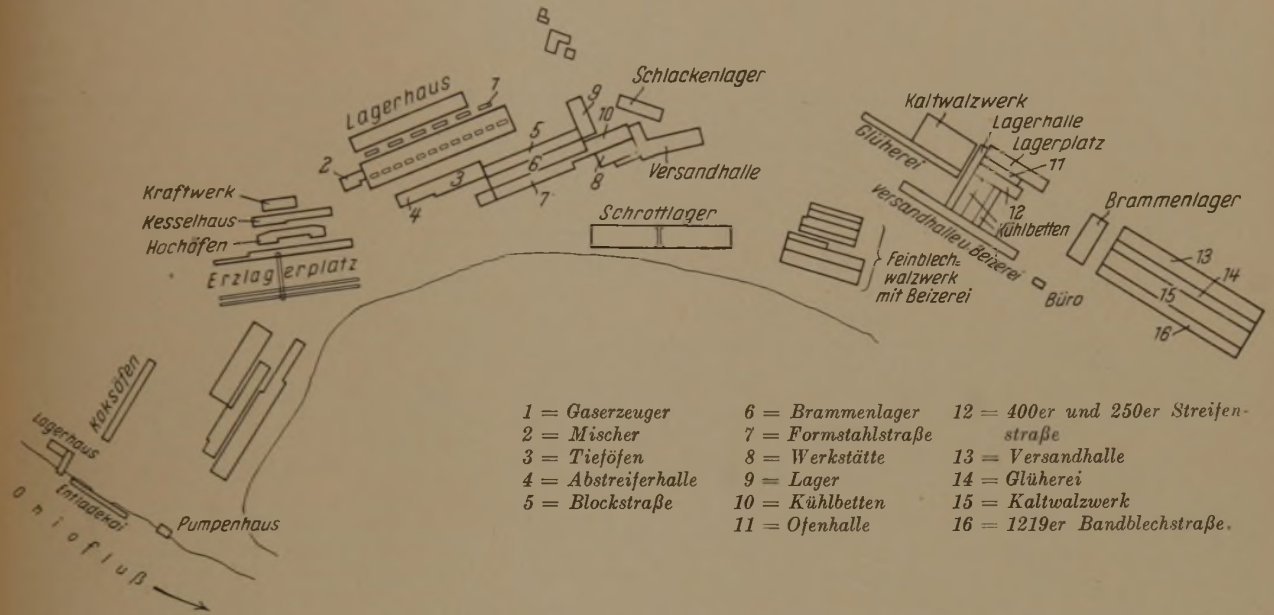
Lageplan der Anlagen der Weirton Steel Company.
